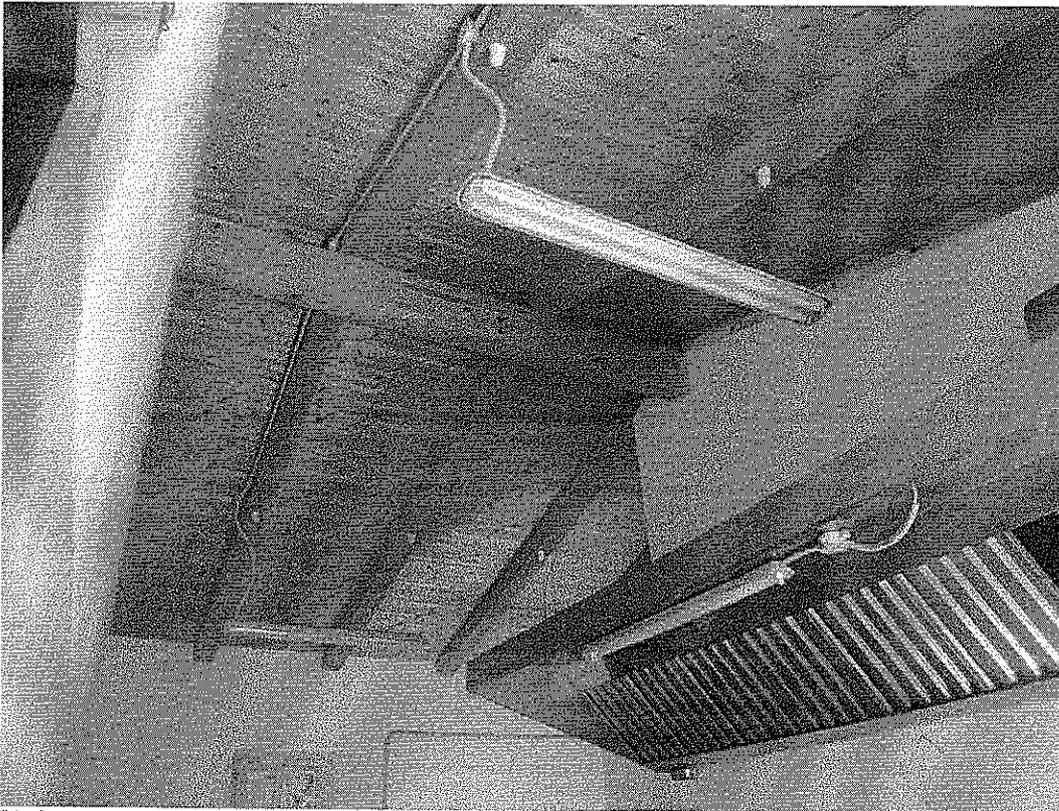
particolare porzione di tetto ristrutturato (abitazione sub.3 e parte di magazzino sub.4)
